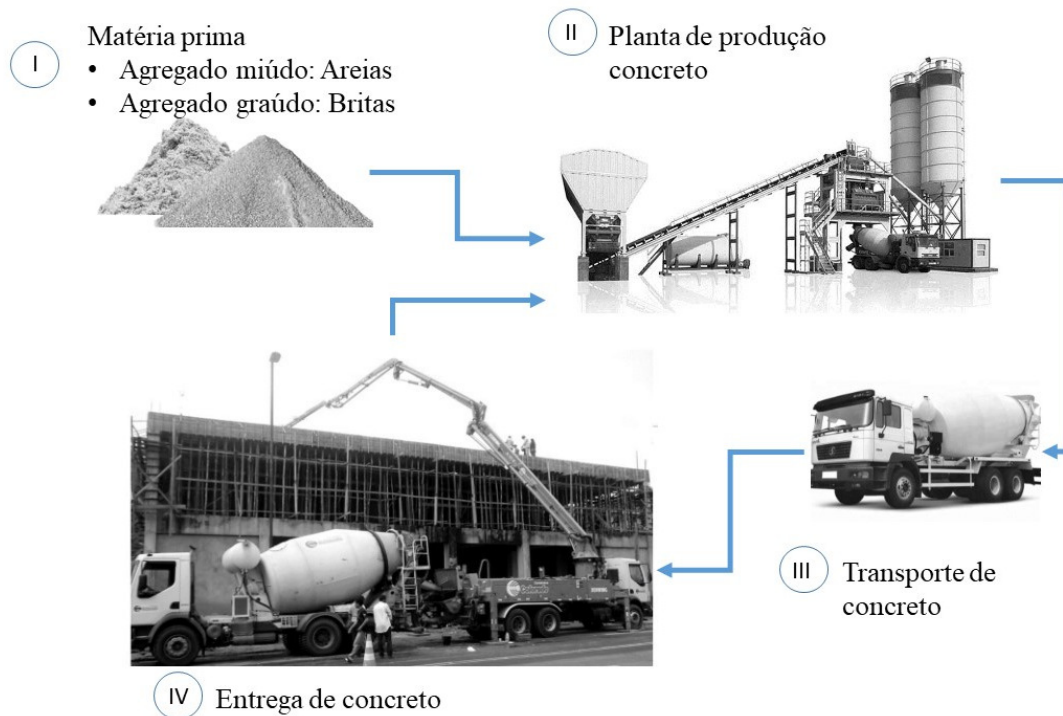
Fluxo das atividades em uma planta dosadora de concreto.
